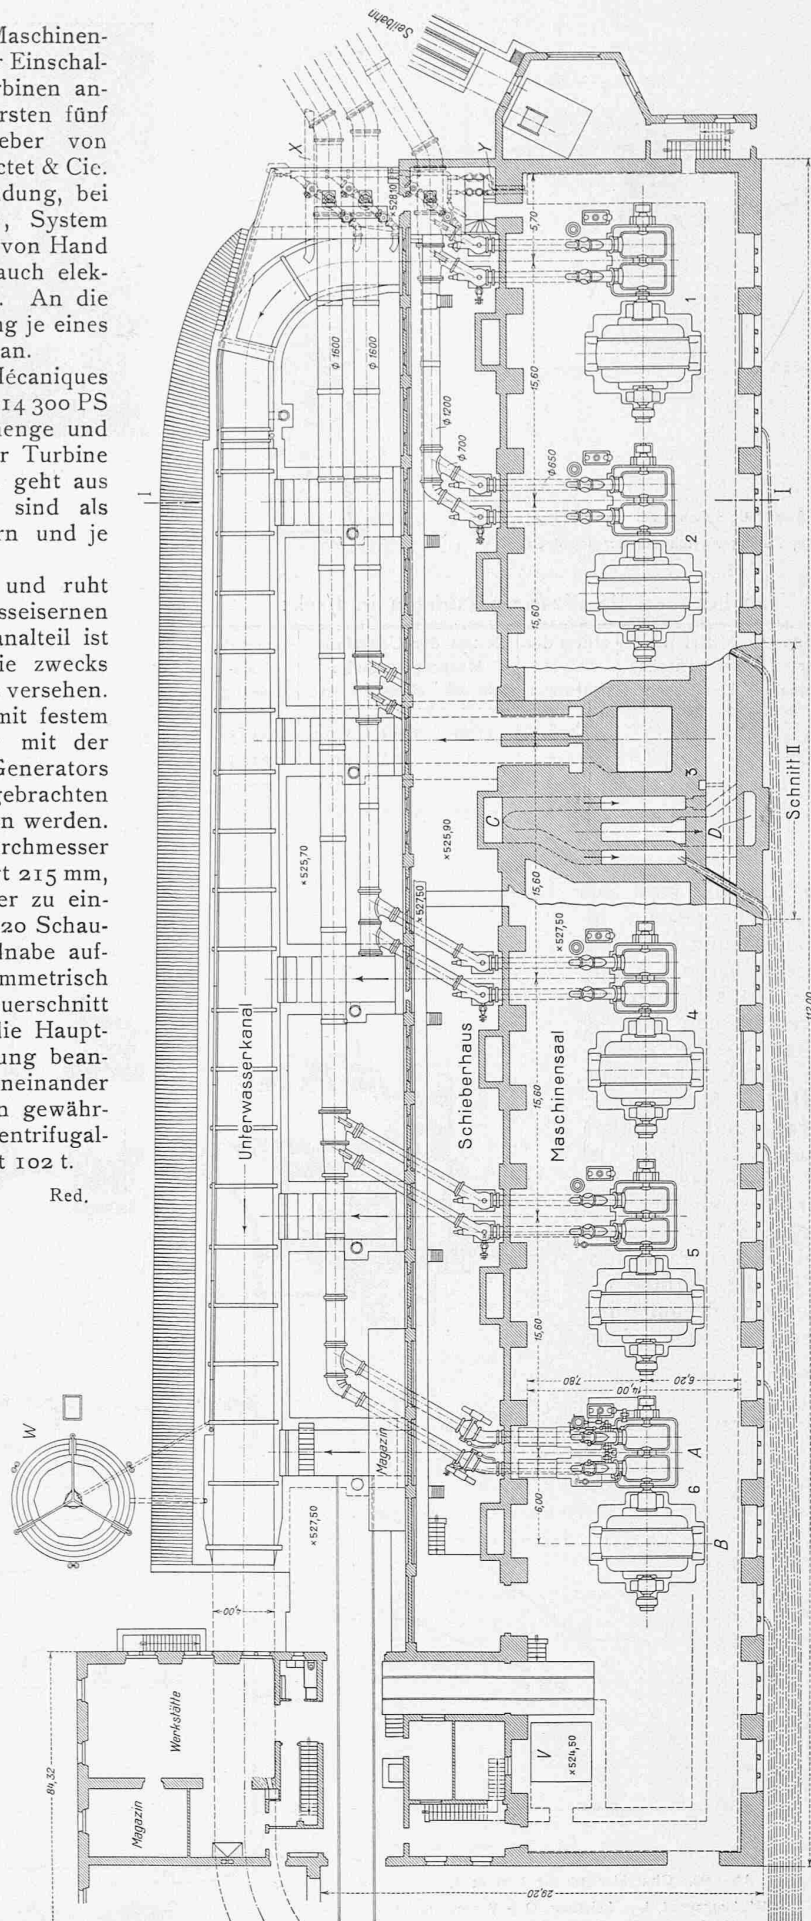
Grundriss von Maschinen- und Schieberhaus, 1 : 450. — Legende : A Turbinen, B Generatoren, C Frischluftkanal, D Warmluftkanal, V Transformatorgrube, W Belastungswiderstand, X Stollenentleerung, Y Kühlwasserleitungen.
